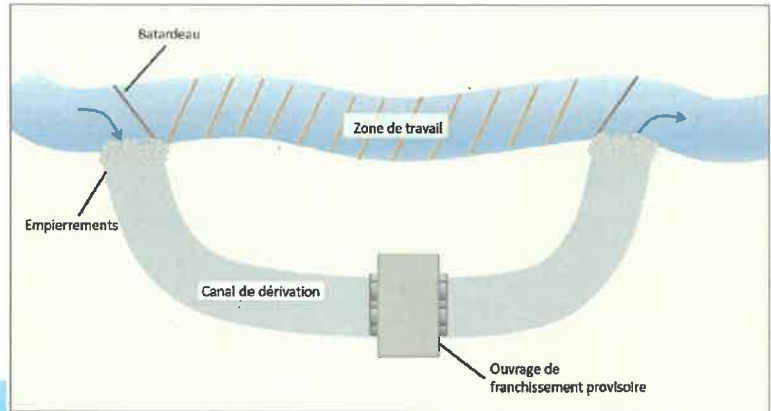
Schéma type d'une dérivation provisoire de cours d'eau
